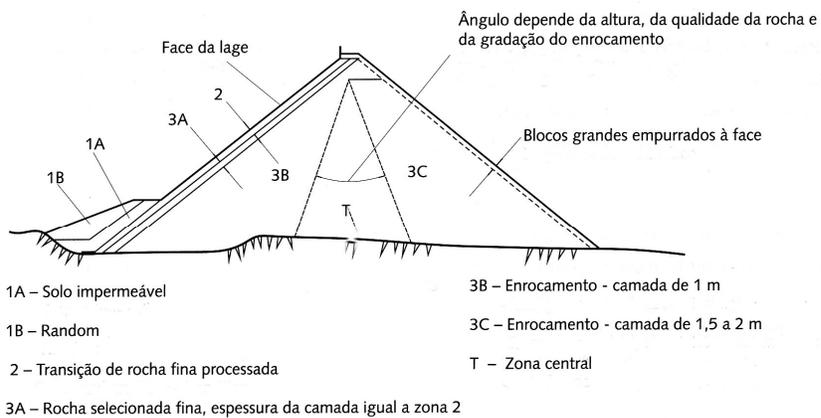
Designação das zonas do corpo de uma barragem de enrocamento são com cortina de betão (Cooke & Sherard, 1987)
